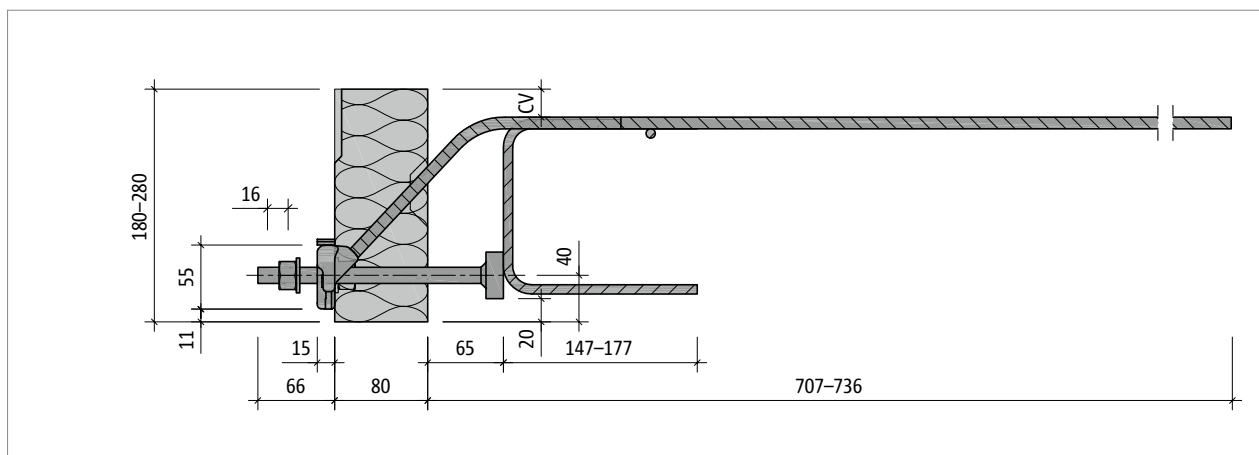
Schöck Isokorb® T type SQ-V2 : coupe du produit
